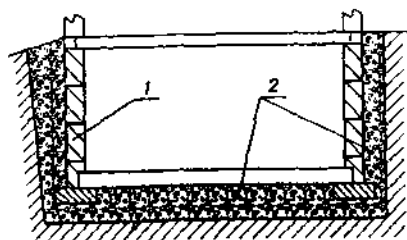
Схема наружной гидроизоляции подземного сооружения:
